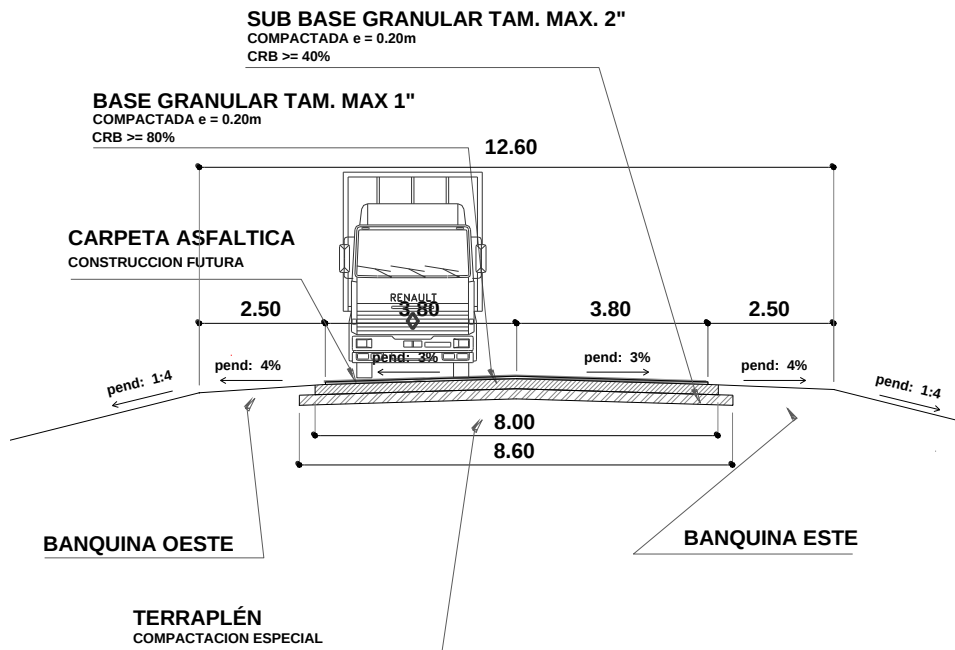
Perfil Transversal "Tipo" del camino de acceso
